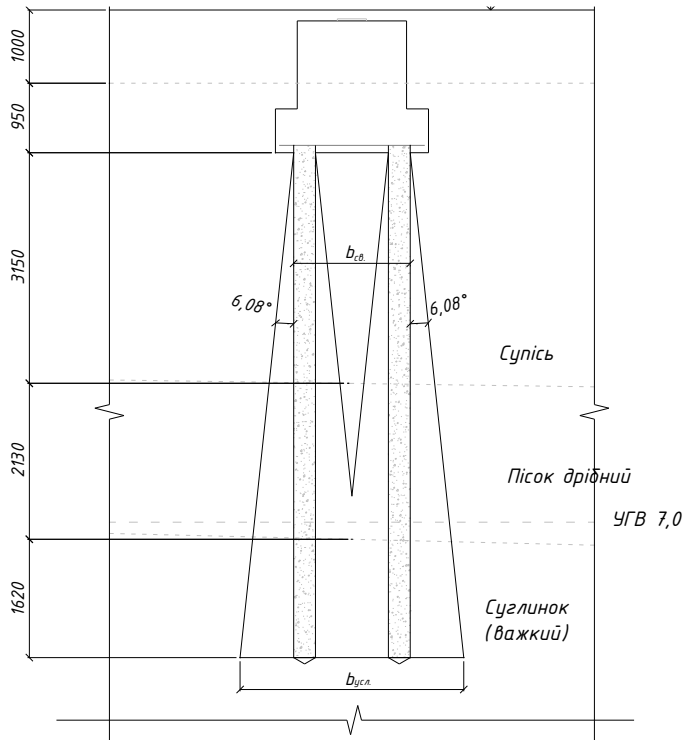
Схема розрахункових значень для визначення тиску під нижнім кінцем пальового фундаменту
